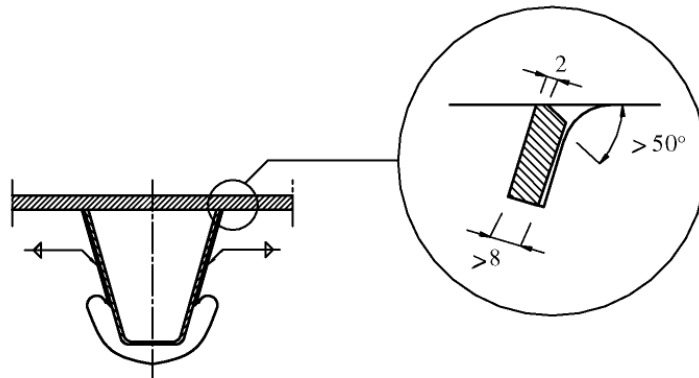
C.19 Preparación de la soldadura de la unión rigidizador-chapa de tablero
